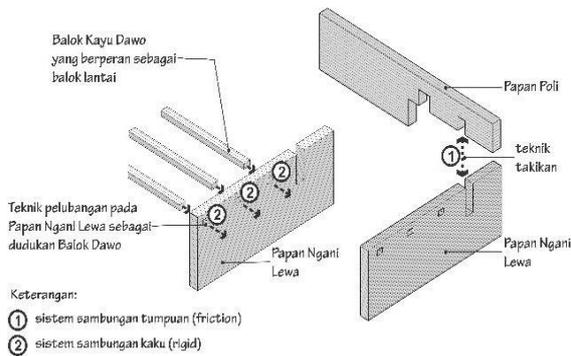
Tahapan Konstruksi Struktur Lantai, 2019
